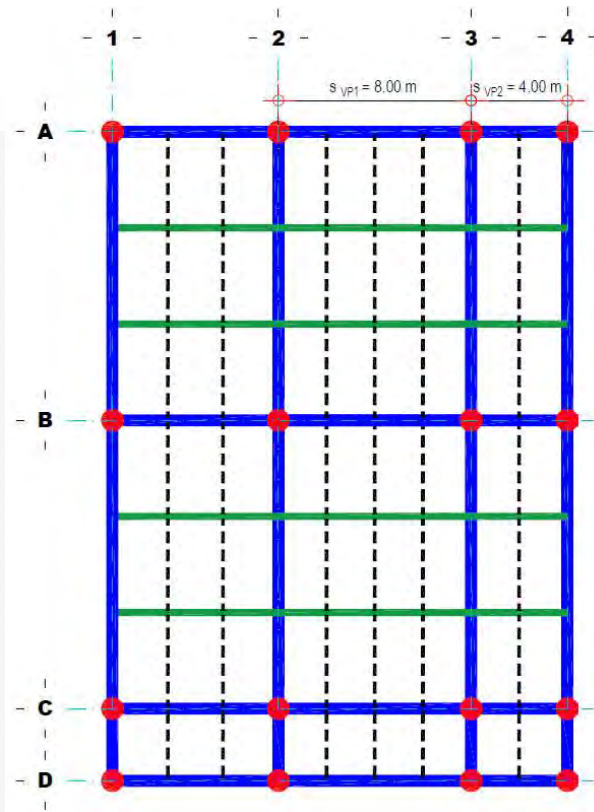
Separación entre vigas principales. Fuente: Elaboración propia.
